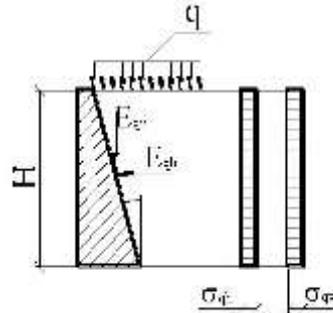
К определению давления грунта от нагрузки на поверхности засыпки
